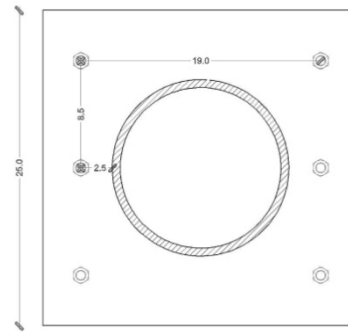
Unione bullonata tra pilastro e piastra di fondazione
